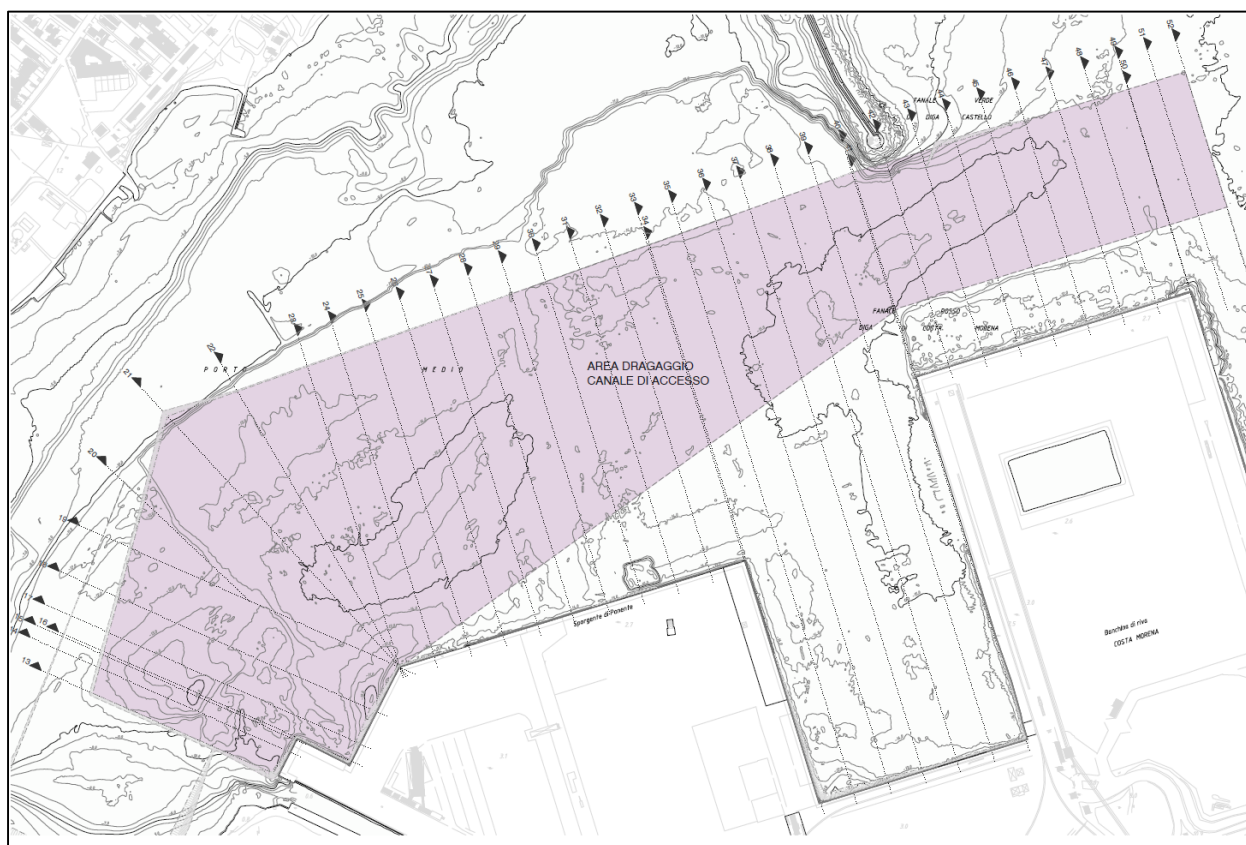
Planimetria di dragaggio Canale di accesso al porto
